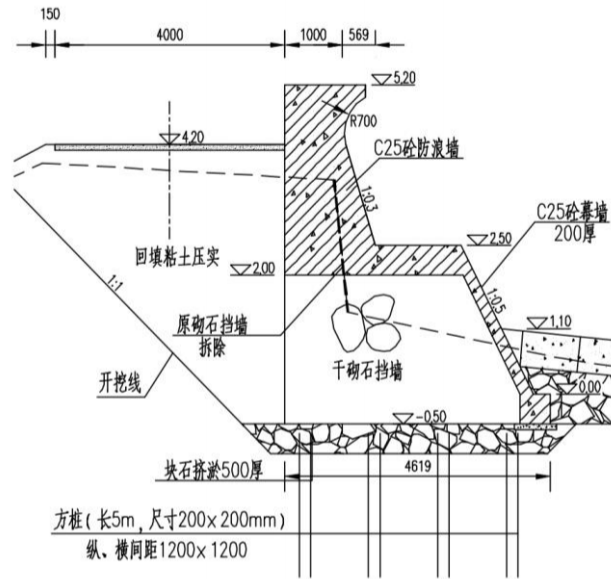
干砌石+砼幕墙挡墙断面图
